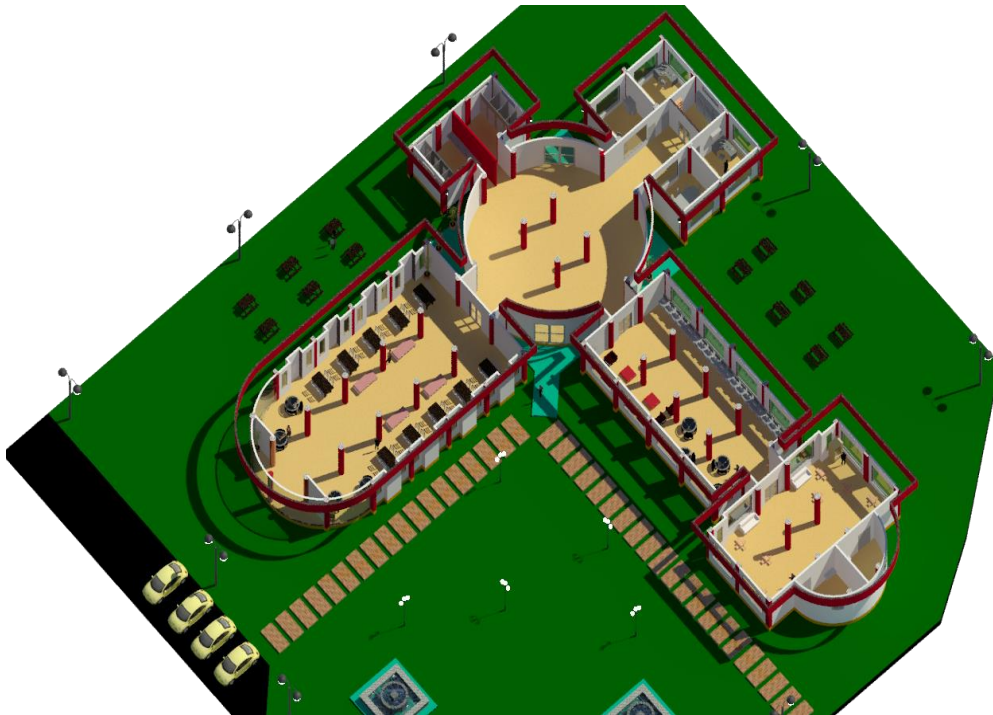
Modelo arquitectónico #4 en 3D de la biblioteca, modelado en Revit.
